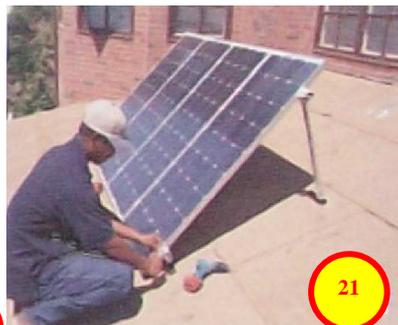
Sistema "Tile Track Rack, para cubierta inclinadas con distinto ángulo que los paneles.
